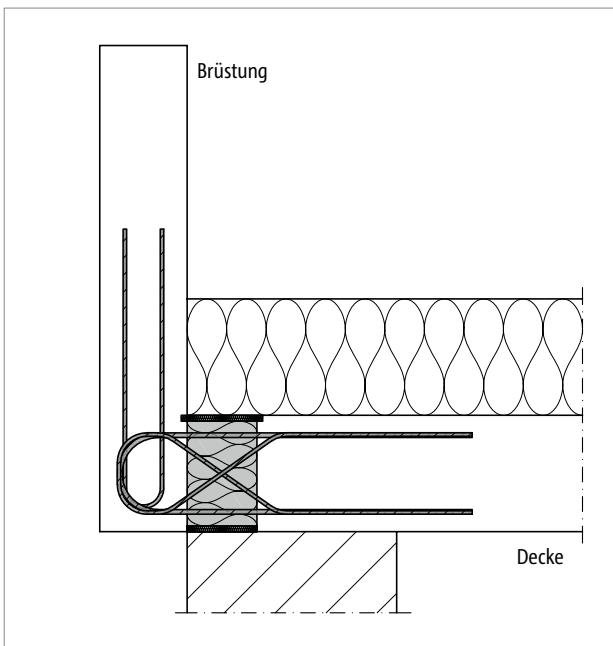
Schöck Isokorb® XT Typ F: Anschluss einer vorgesetzten Brüstung bei wärmedämmendem Mauerwerk
